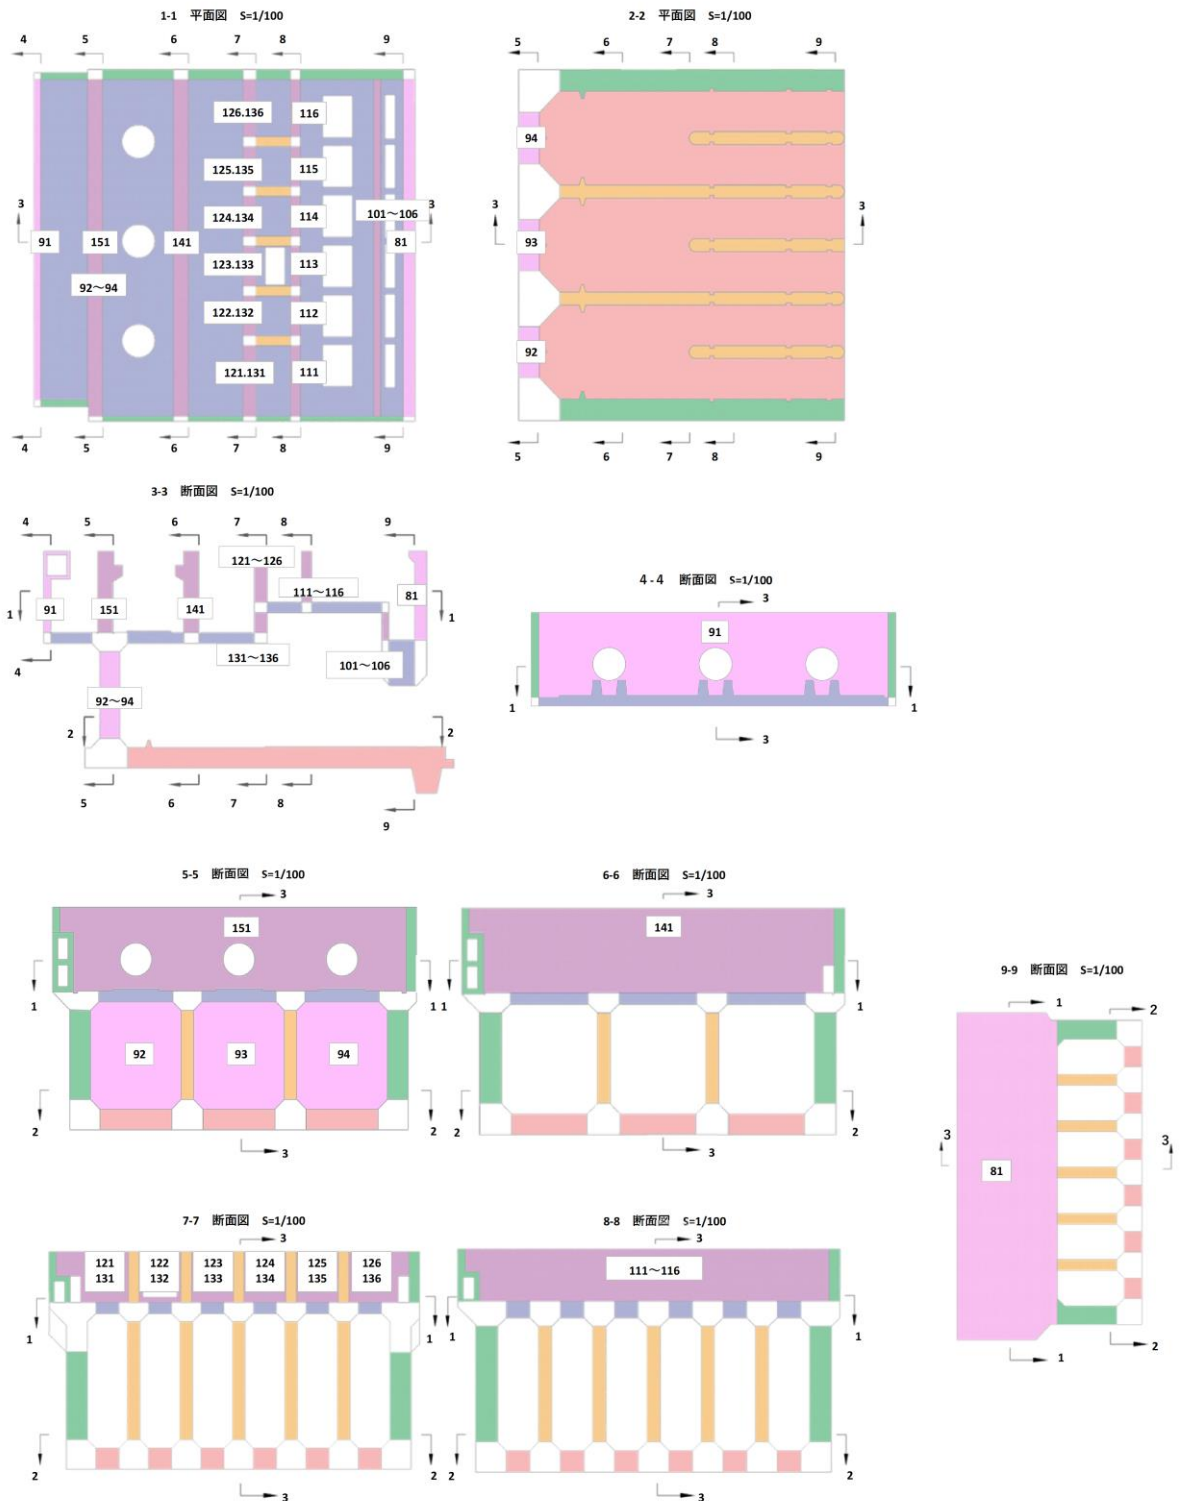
(3) 評価位置図 (曲げ・軸力系の破壊及びせん断破壊)
